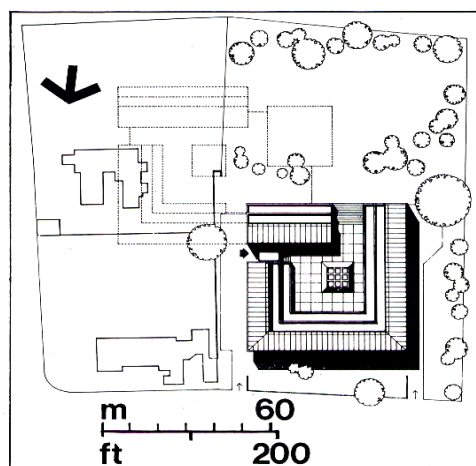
Quince House Harvard University. Cambridge, Massachussets. 1960.
